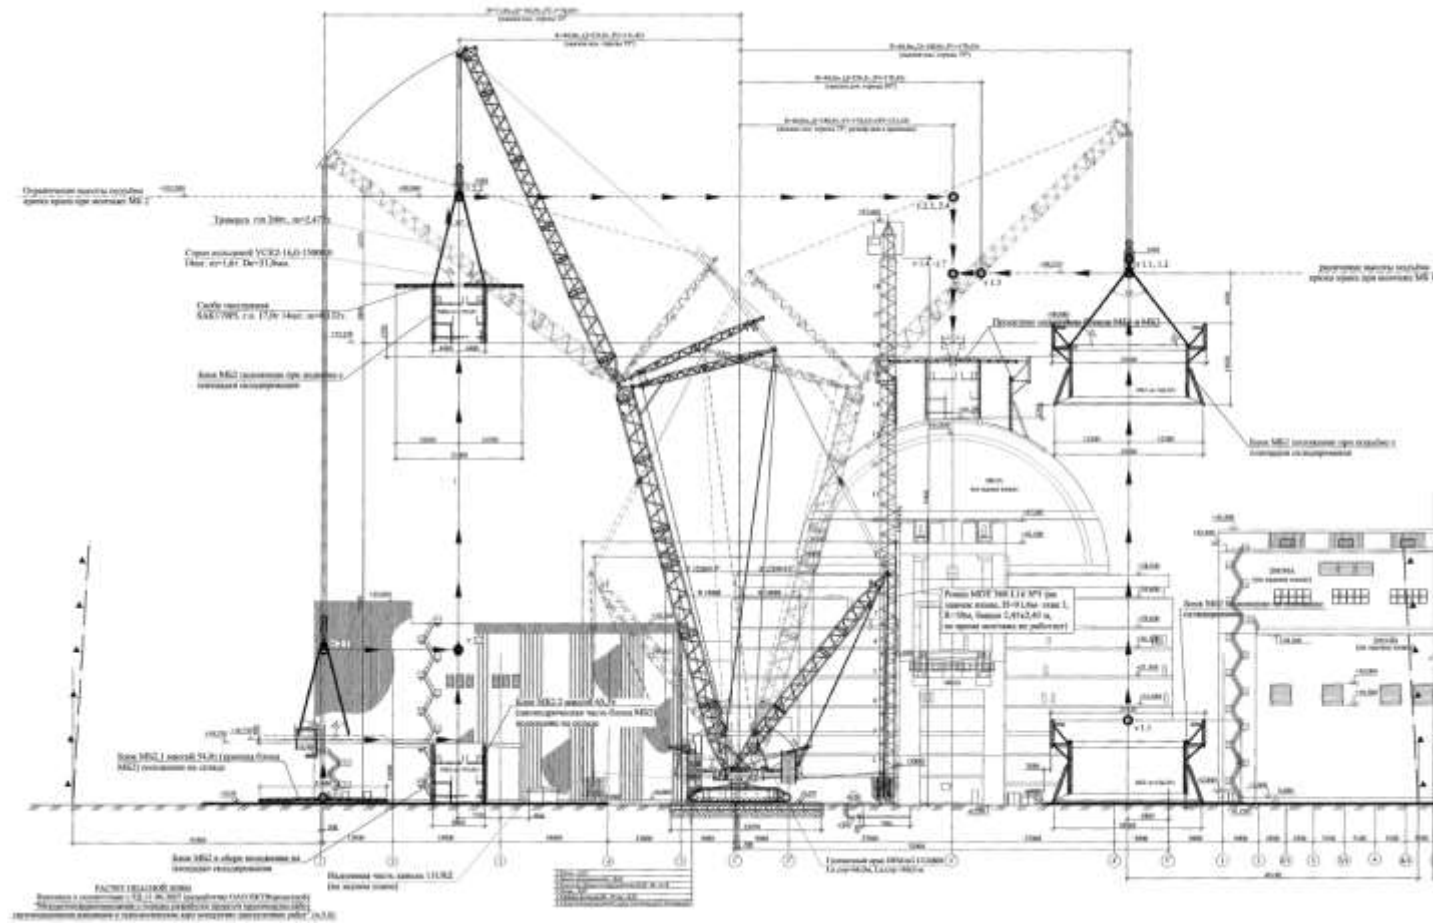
Типовая схема установки блока стальных строительных конструкций СПОТ
